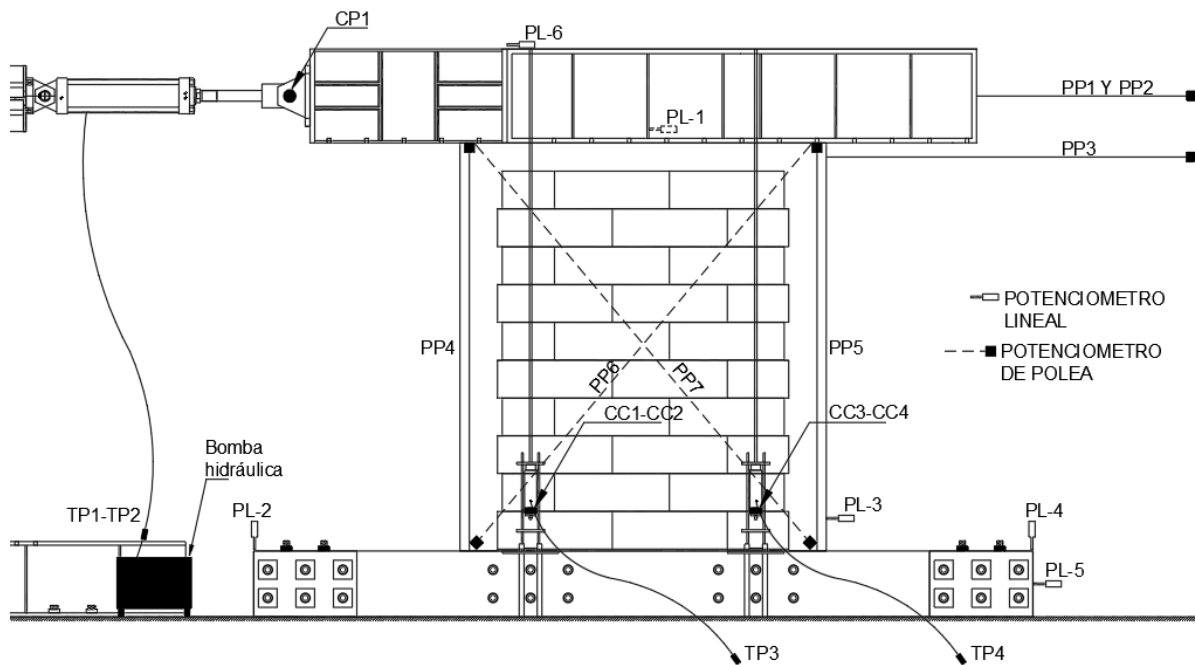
Esquema del sistema de instrumentación muro M-1.23-7.2
